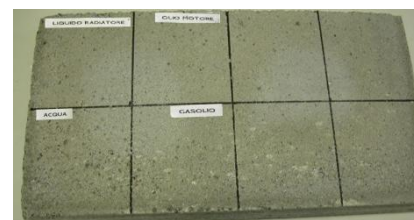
Aspetto del massetto trattato al termine dei vari test
